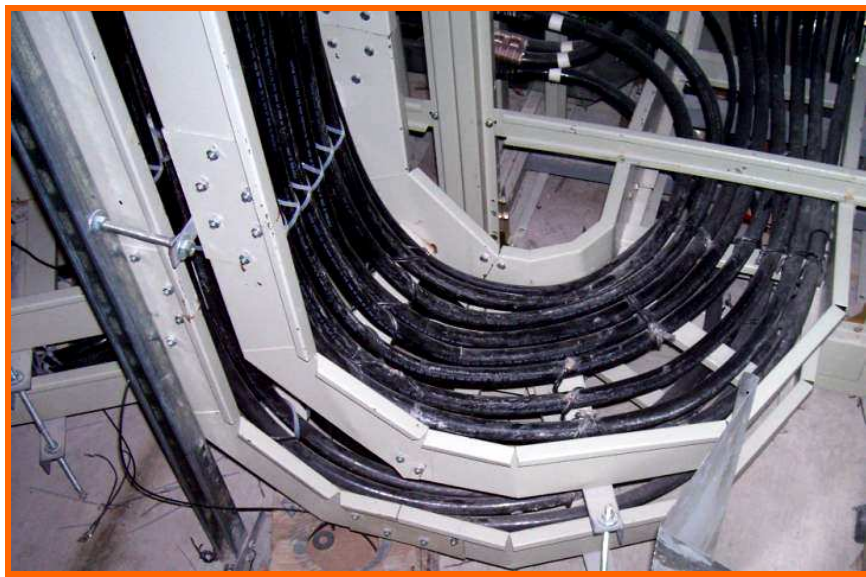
Peinado de Cable de fuerza por bandeja portacable.
